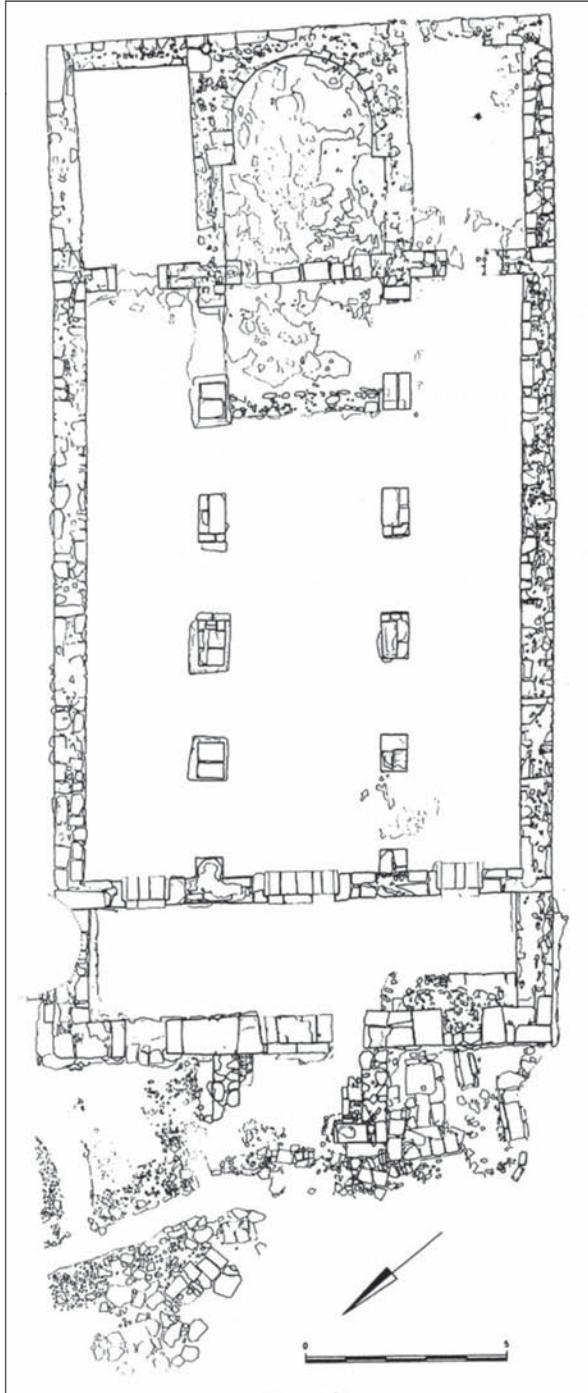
Planta de la basílica menorquina de Son Bou (Orfila y Tuset, 1988)
